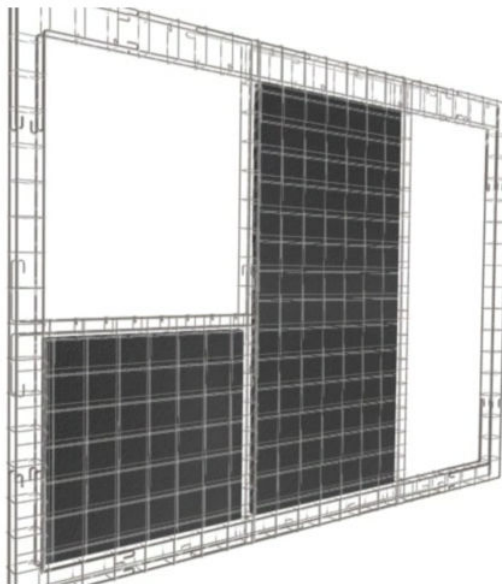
Muros perimetrales prefabricados de hormigón con aislación incorporada.
